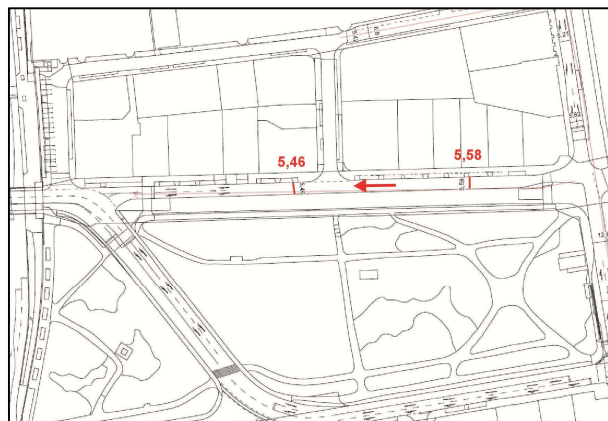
Sanderring (Sanderstraße bis Sanderglaxisstraße) - Lageplan
